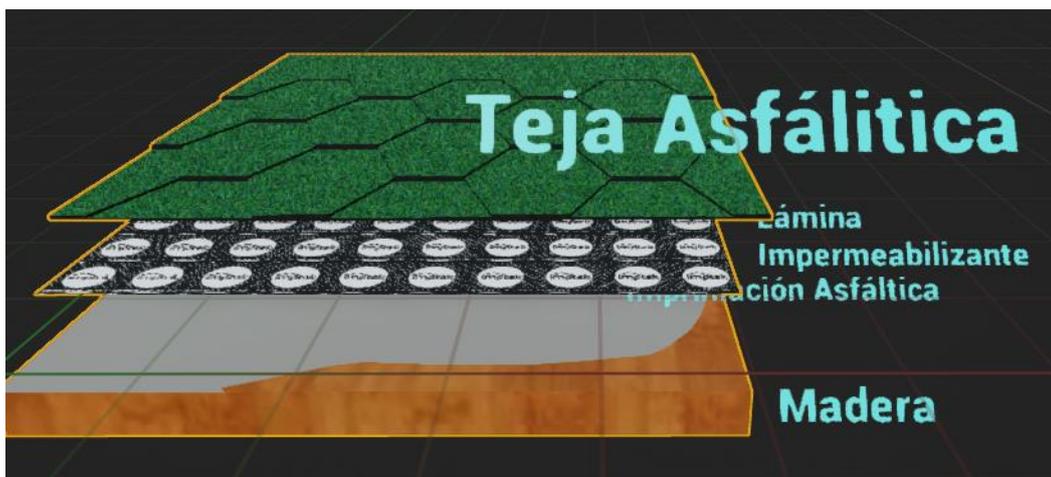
Sistema de impermeabilización – Cubierta inclinada.
